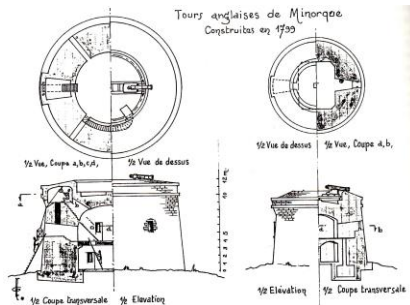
Esquema de plantas y alzados de las torres artilladas inglesas construidas en Menorca.
